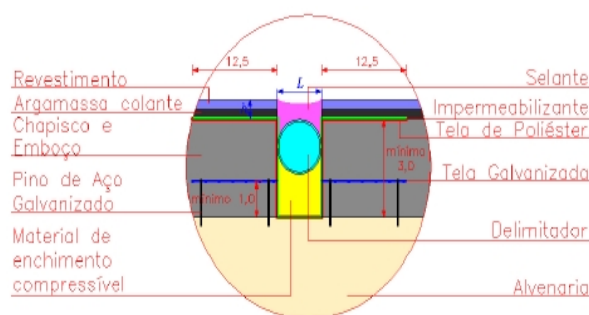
Junta vertical e horizontal detalhada no projeto de fachada.
